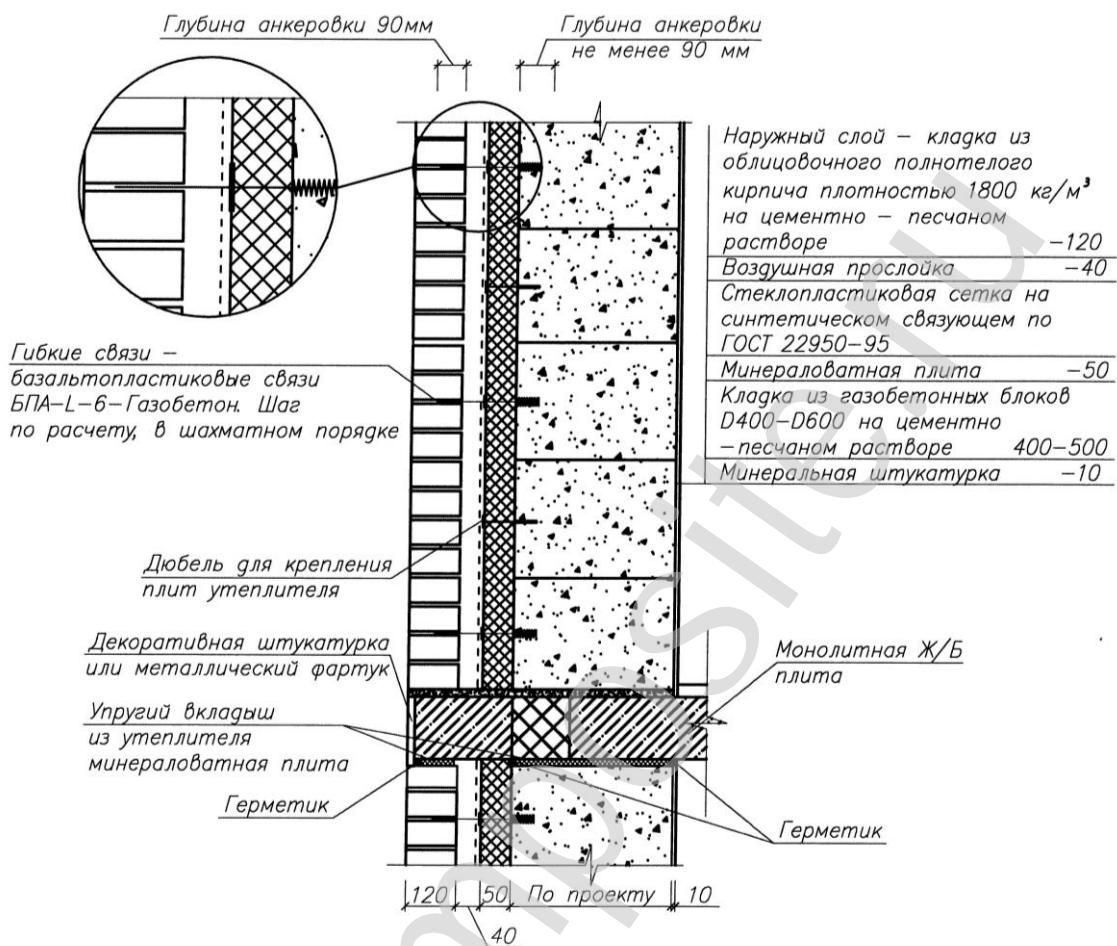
Поперечное сечение стены и схема расположения слоев с применением газобетона и дополнительным утеплителем
